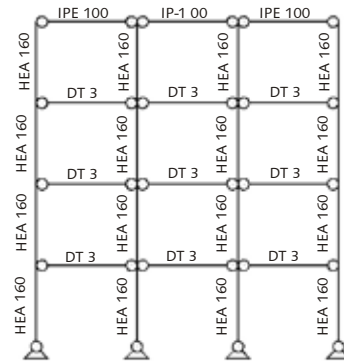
Grundriss Gelenk I - Haus 1
